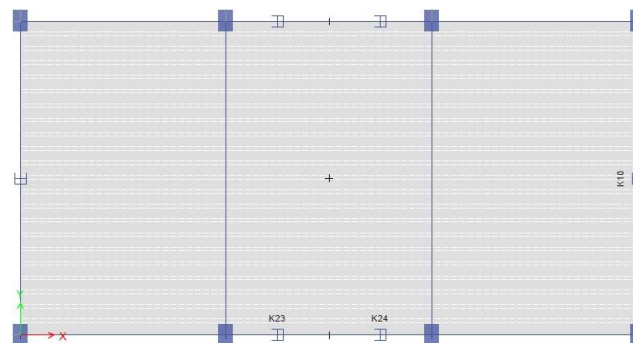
Modelo estructural – Edificio apuntado (1-5 niveles)
